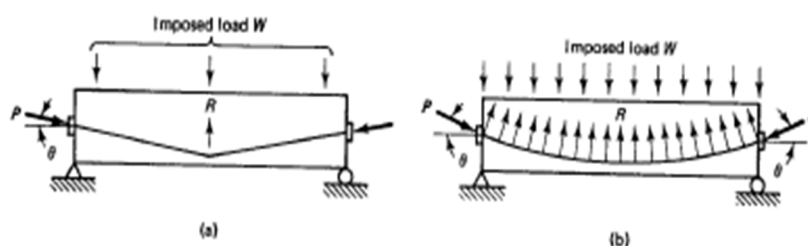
Cargas balanceadas. (a) Tendón tipo harped. (b) Tendón tipo draped.
